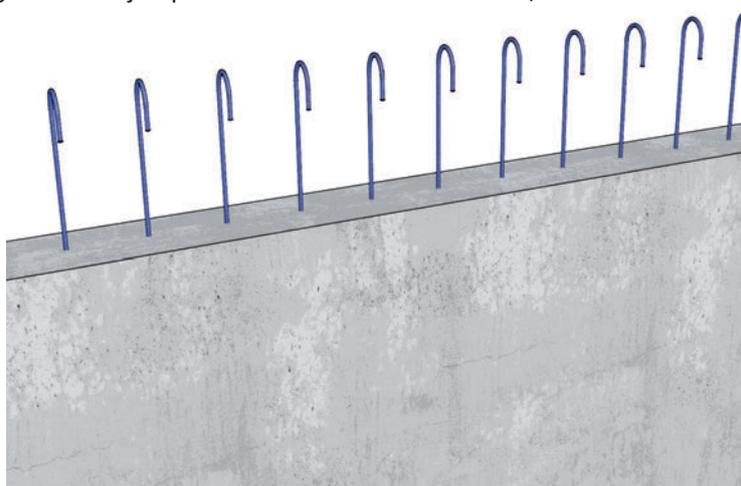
Solution 1 – Voile arasé en sous-face de dalle :
